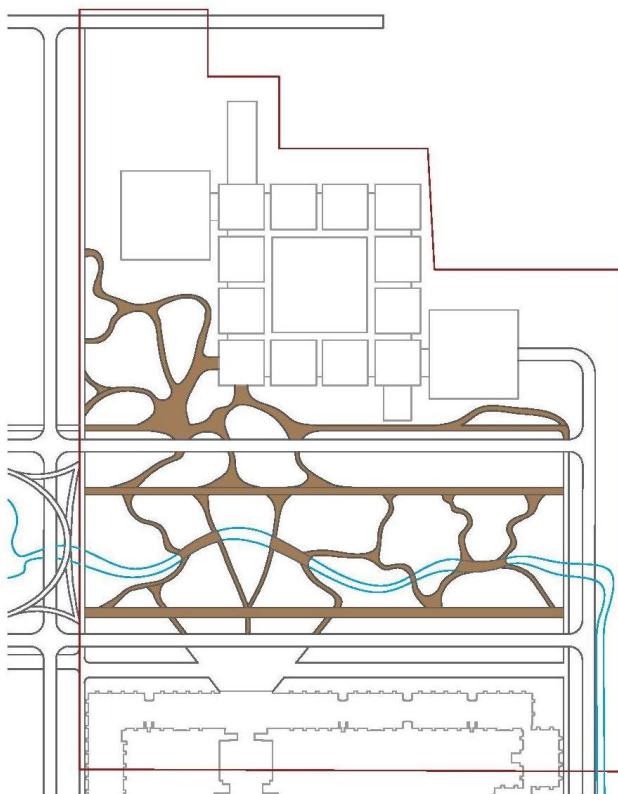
План прокладки дорожек в зоне березовой рощи
